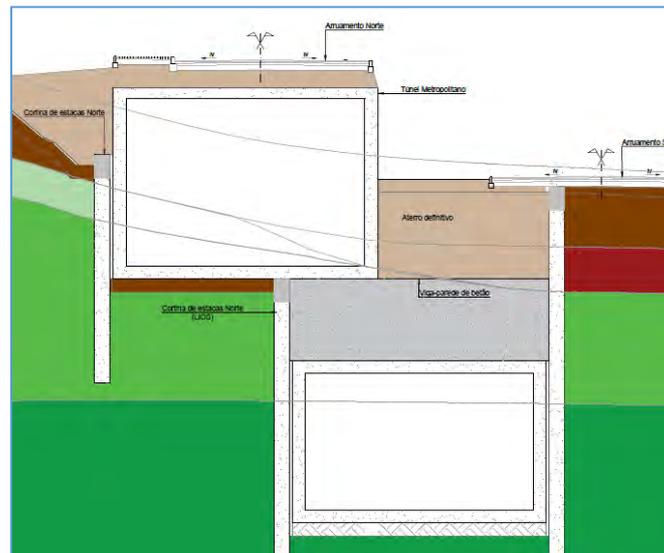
Secção Tipo da solução de ligação entre o Túnel do Metro e Túnel do LIOS (sem escala)
